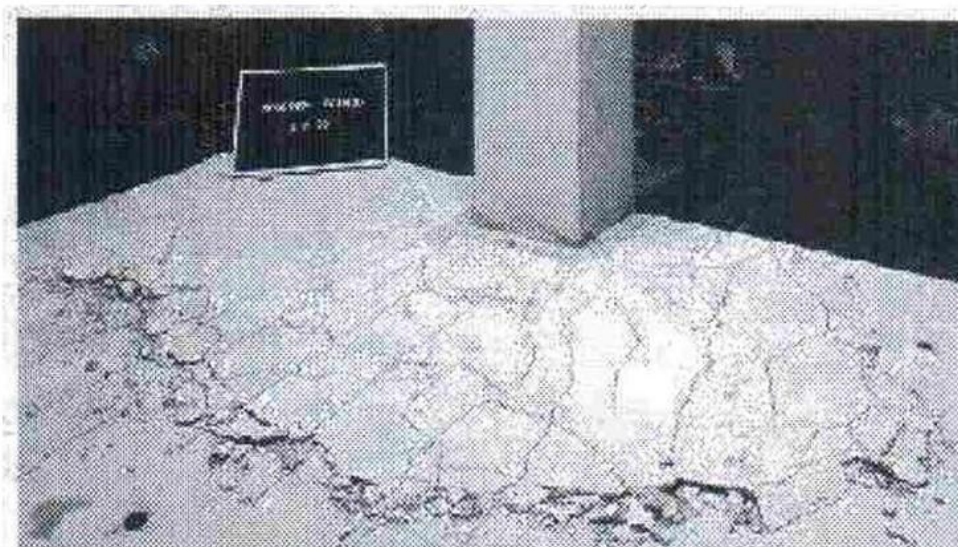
Apparition de fissures au voisinage du poteau [13]
